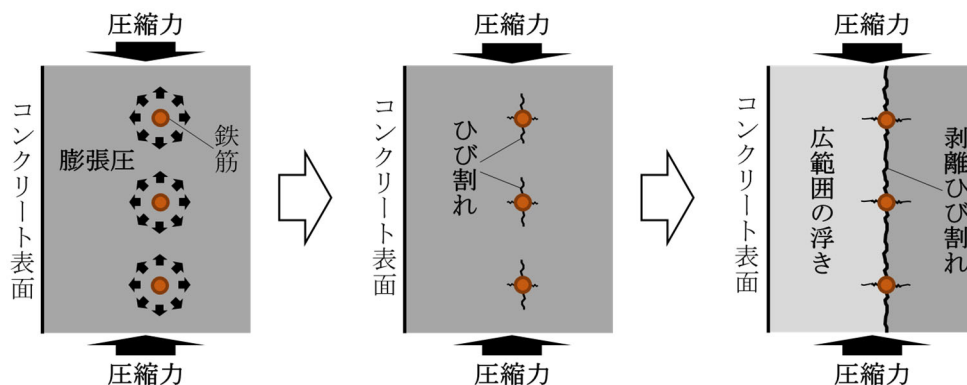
剥離ひび割れの発生メカニムのイメージ図
